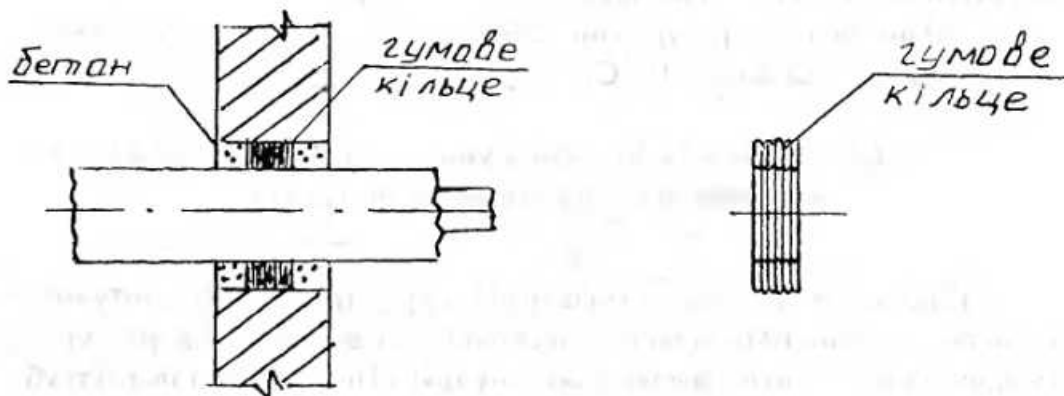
Схема проходження ізолюваного трубопроводу через будівельну конструкцію
